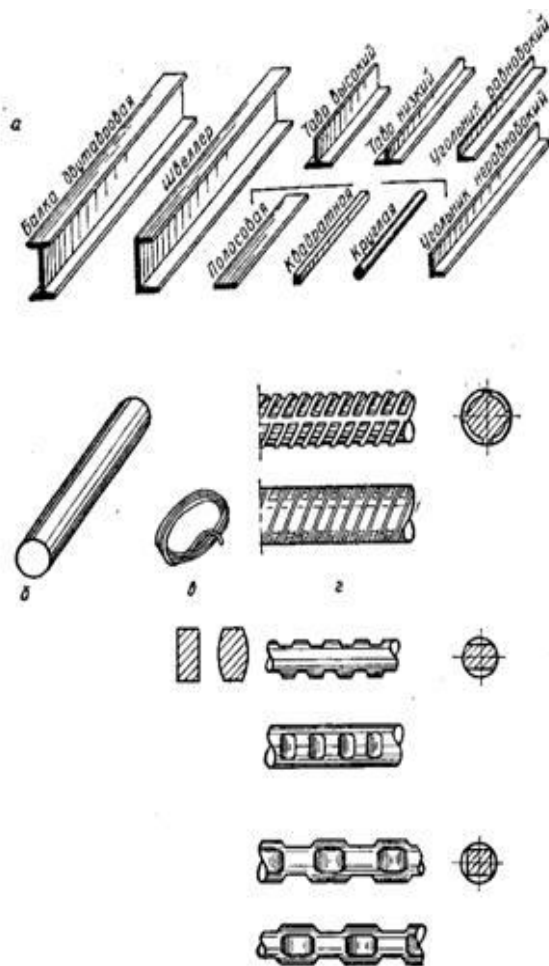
Виды стальных материалов: а - балки, швеллеры и другие прокатные изделия, б - круглая арматурная сталь, в - проволока арматурная, г - стальные арматурные стержни периодического и сплюснутого профиля.
